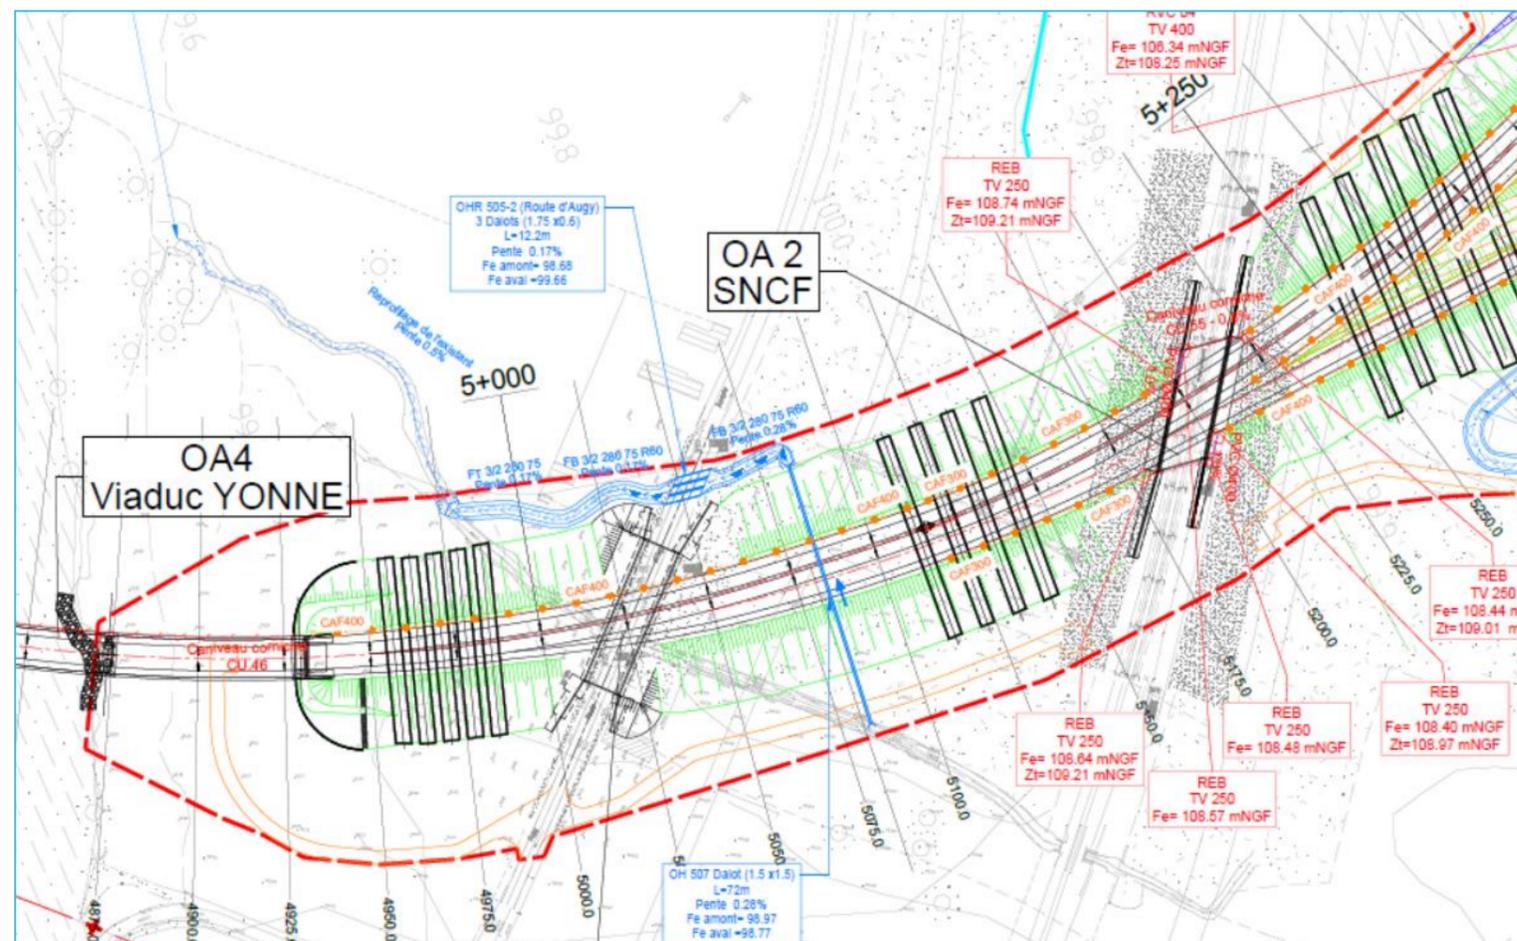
Vue en plan des ouvrages de décharge (source : Setec 2023)
